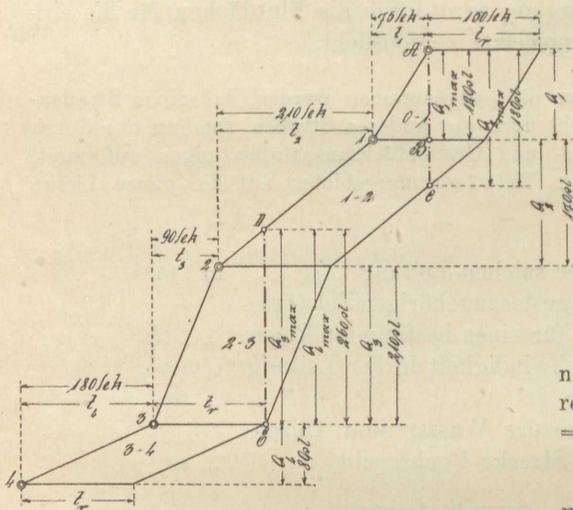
Flutflächen für die Punkte 1, 2, 3 und 4 einer Leitungsstrecke (Flutplan).
